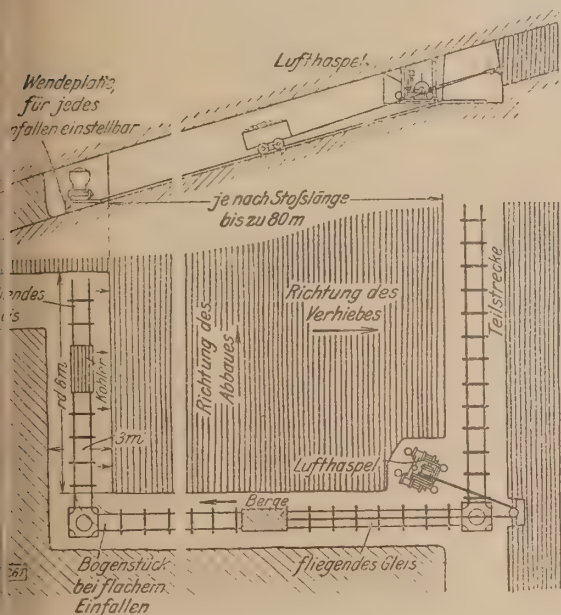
und 35. Haspel-Abbauförderung im Unterwerksbau mit schwebendem Verhieb (Grundriß und Querprofil).
